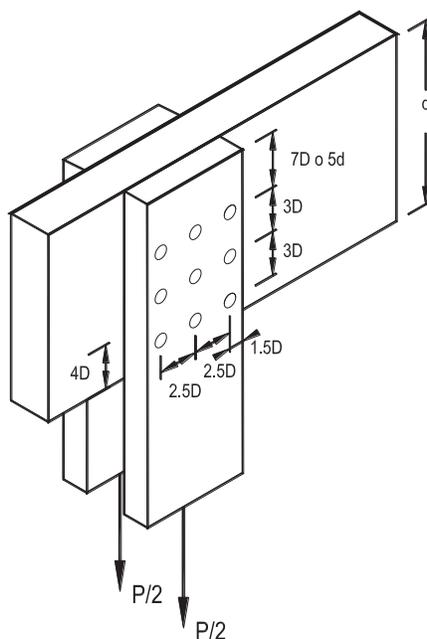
Espaciado entre pernos de uniones con cargas paralelas a la fibra.
